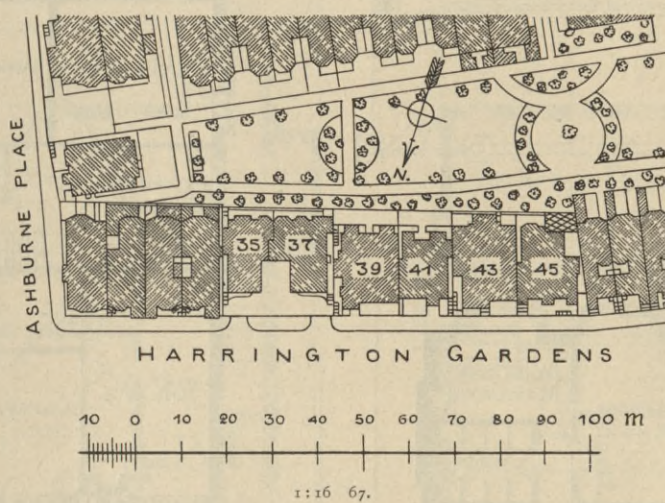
Lageplan der Häuser Harrington Gardens 35 bis 45.
